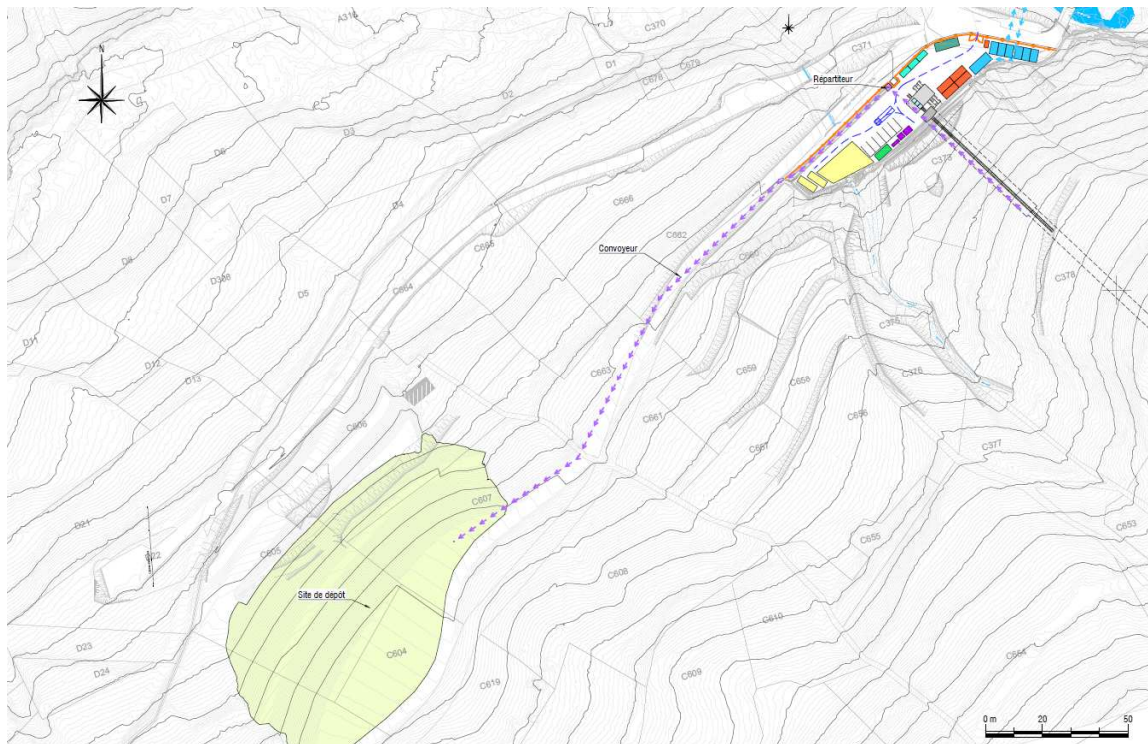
Aménagement de la plateforme et du site de dépôt le long de la RD211a (installations de chantier en phase travaux)
